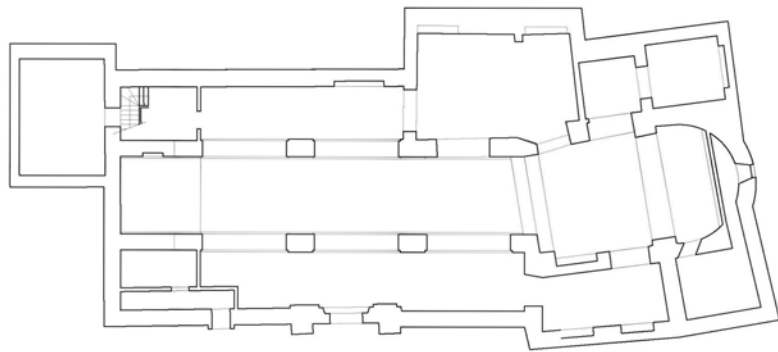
Iglesia de Santo Tomé. Planta general. Plano: Cristina Trallero de Lucas
